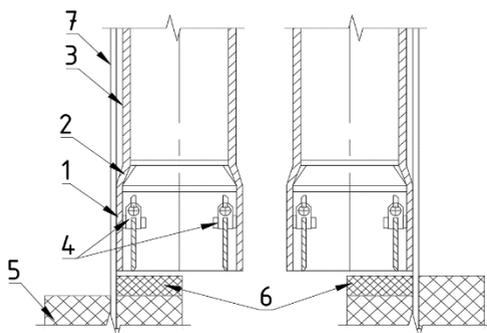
Печать армированных конструкций: 1 – сопло, 2 – переходник, 3 – корпус печатающей головки, 4 - подвижный элемент клапана, 5 – слой ранее уложенного материала, 6 – свежеложенный слой материала, 7 – арматура
